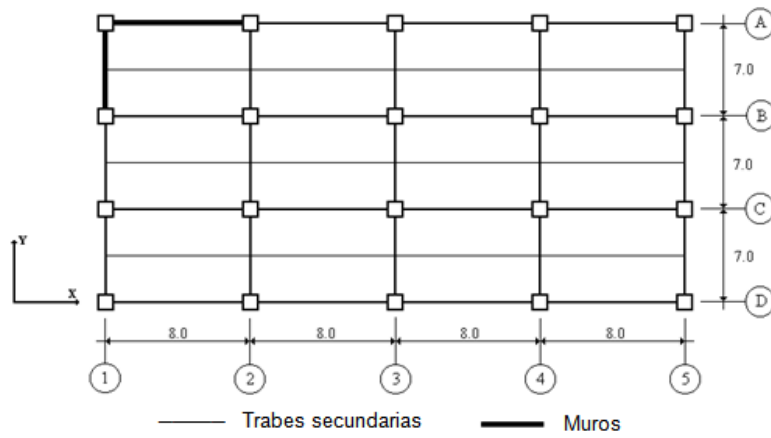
Planta tipo para el modelo de 15 niveles, modelo excéntrico en rigideces, 1 muro en cada dirección.
